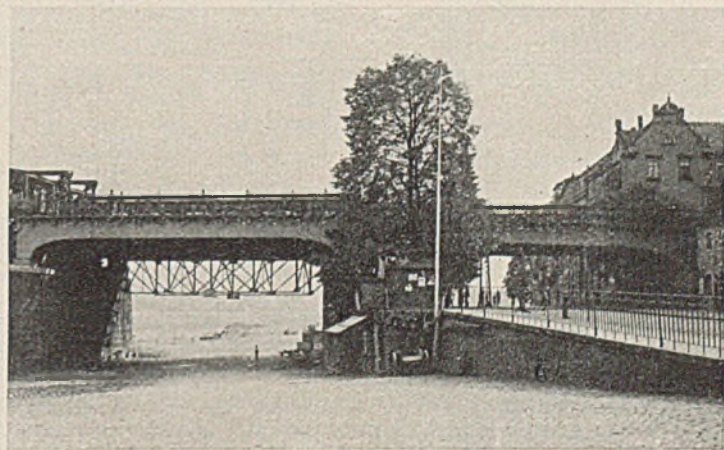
Ansicht des Eisenbetonsteges an der Siebeneichener Straße. (Dahinter die Gerüstträger der neuen Brücke im Feld C-B.)
